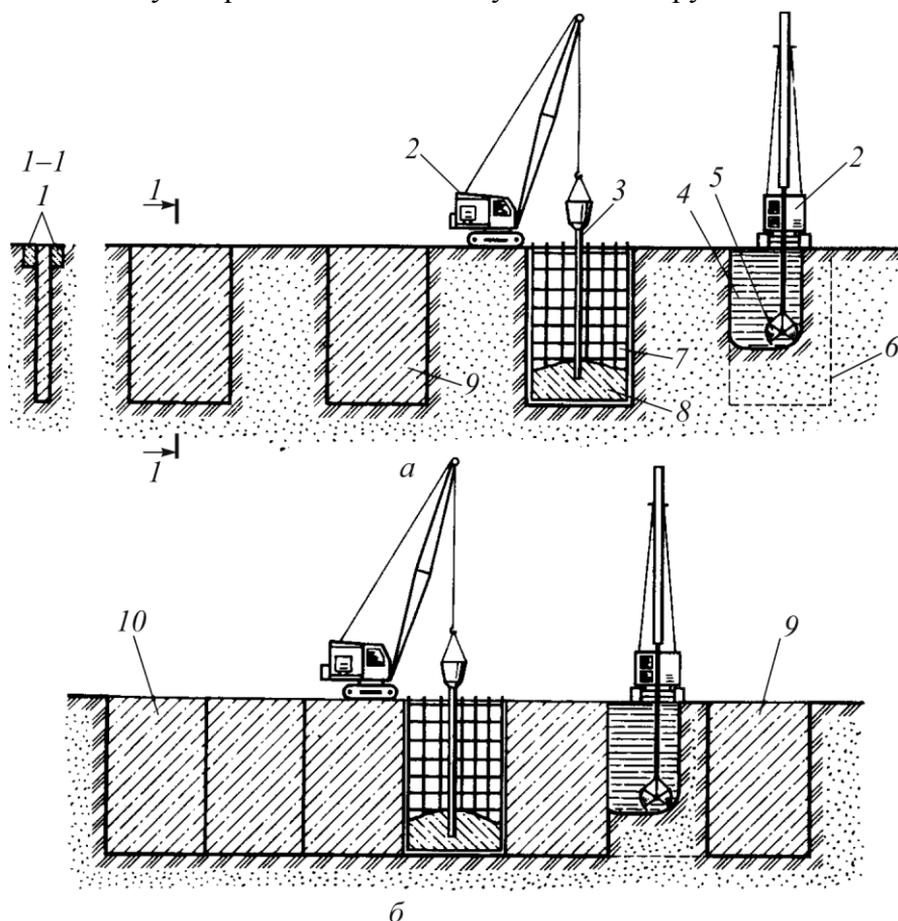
Последовательность производства работ способом «стена в грунте»: *а* – первая очередь работ; *б* – вторая очередь работ; 1 – форшахта; 2 – базовый механизм; 3 – бетонлитная труба; 4 – глинистый раствор; 5 – грейфер; 6 – траншея под одну захватку; 7 – арматурный каркас; 8 – бетонная смесь; 9 – забетонированная секция; 10 – готовая секция «стена в грунте»
